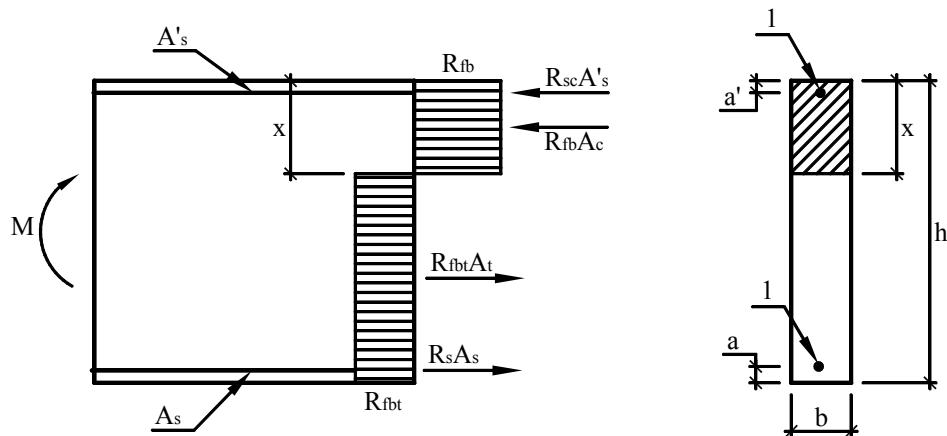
Схема усилий и эпюра напряжений в сечениях, нормальных к продольной оси изгибающего элемента прямоугольного сечения при комбинированном армировании
